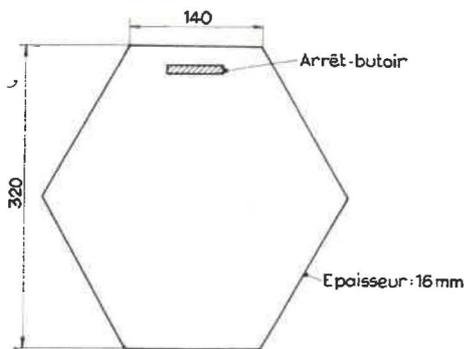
Semelle métallique placée sous le pied des caissons. La section de contact d'une semelle contre le mur est de 900 cm².
